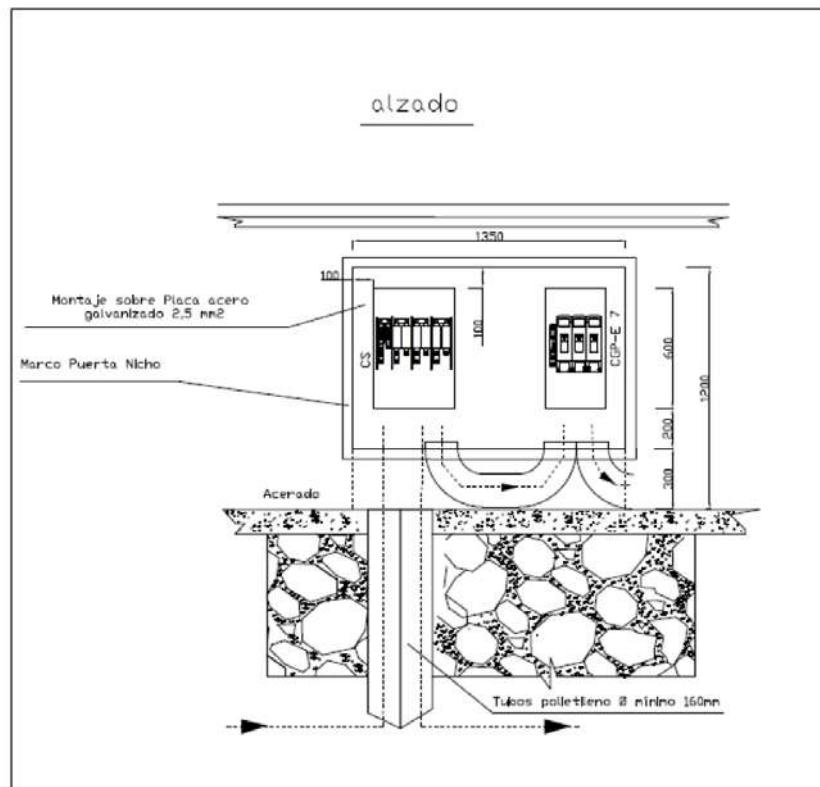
Instalación CGP y CS montaje horizontal. Alzado.
